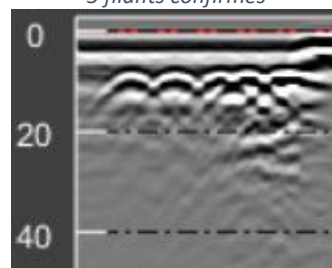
Poutre Pt04 – Travée 4 à 2 m de l'appui
